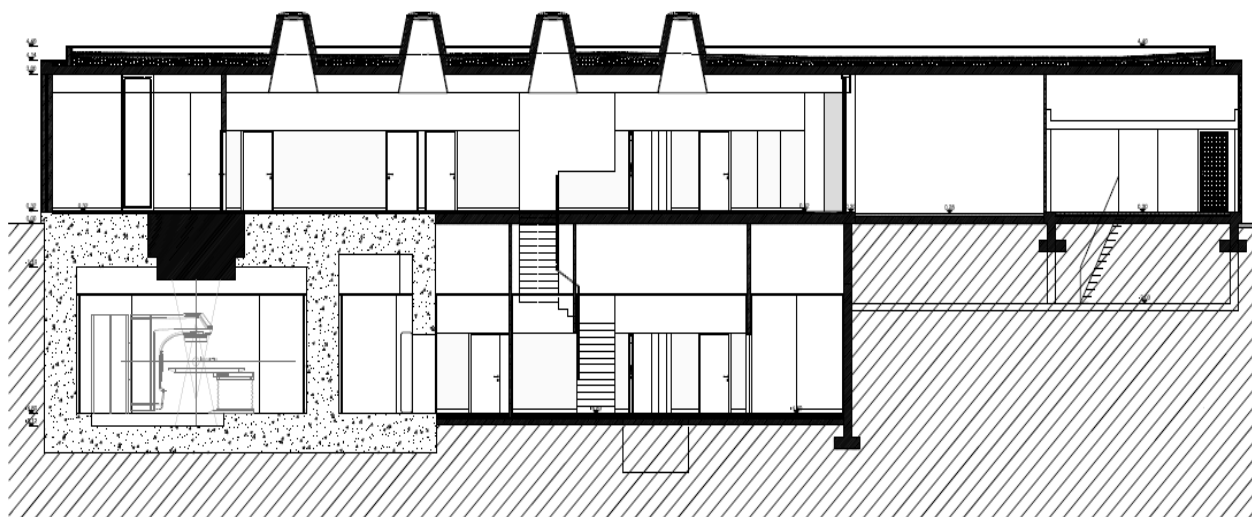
Corte 1 – corte de arquitetura em AutoCad
